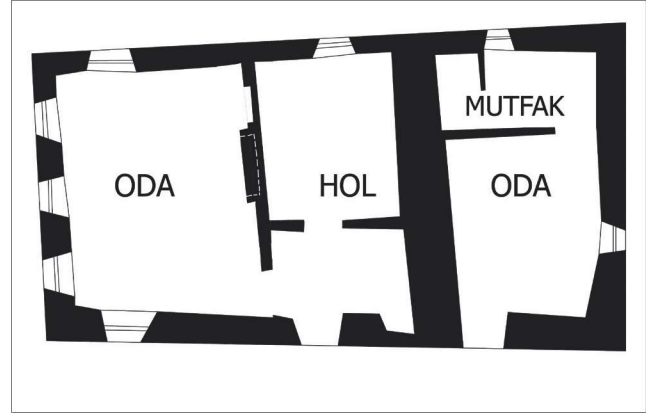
819 Parsel (Tescilli) Zemin Kat Planı / Building lot: 819 (registered), ground floor plan.
